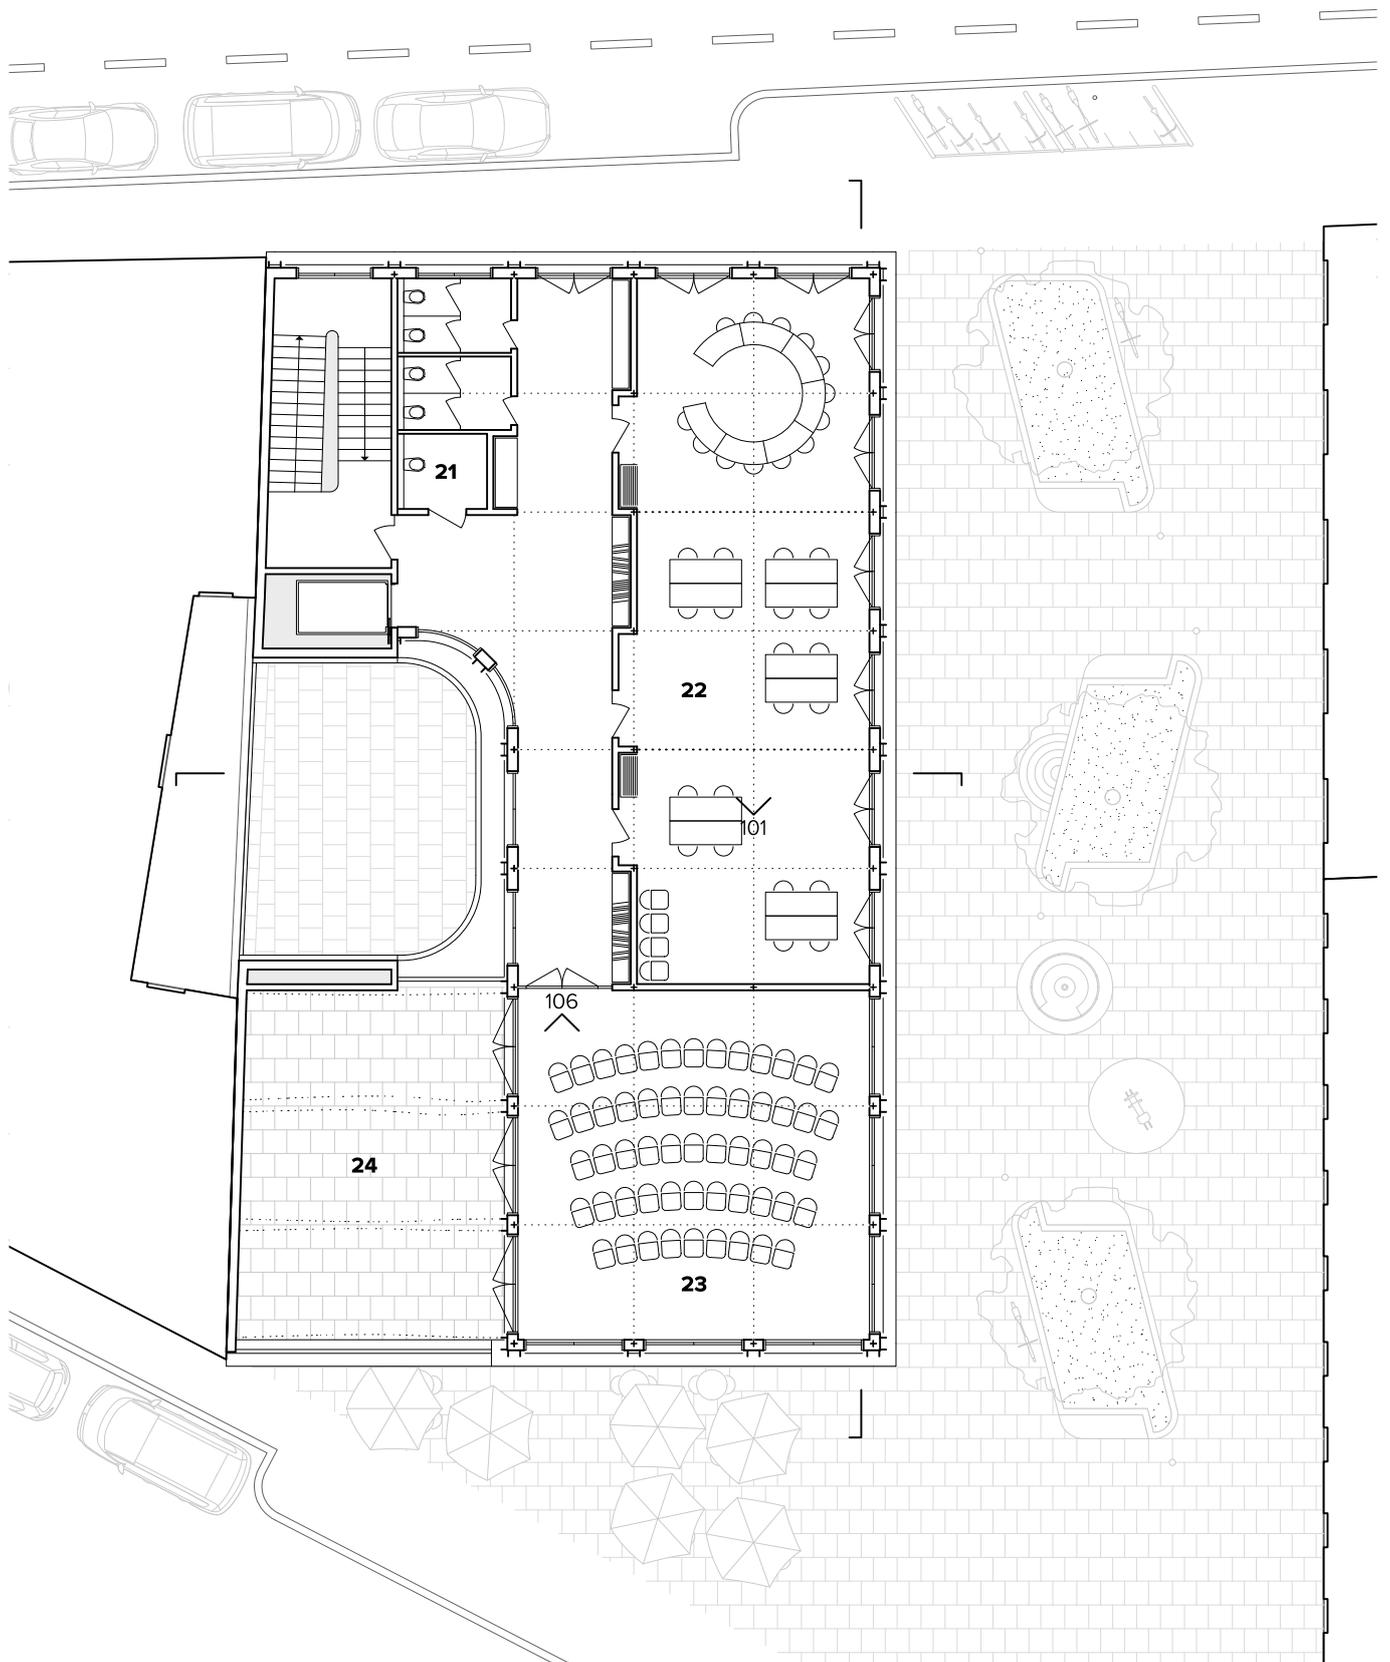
Grundriss 4. Obergeschoss 1.200 (BM)
